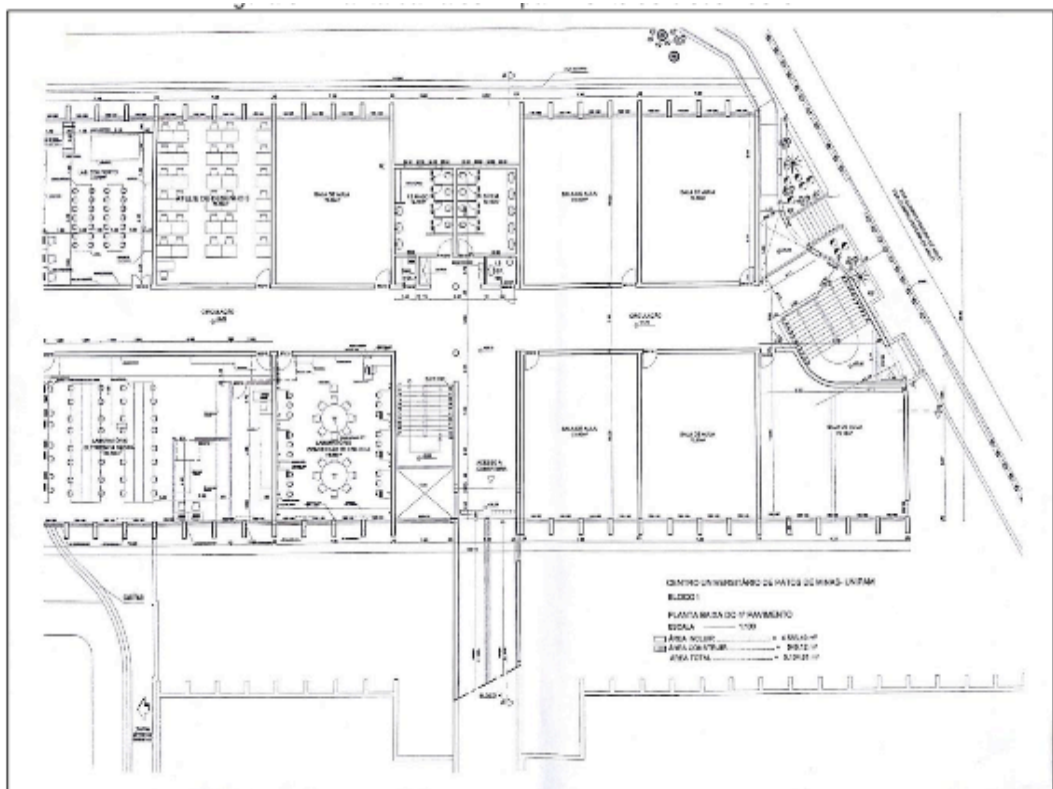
Planta baixa do 4º pavimento do bloco I do UNIPAM
